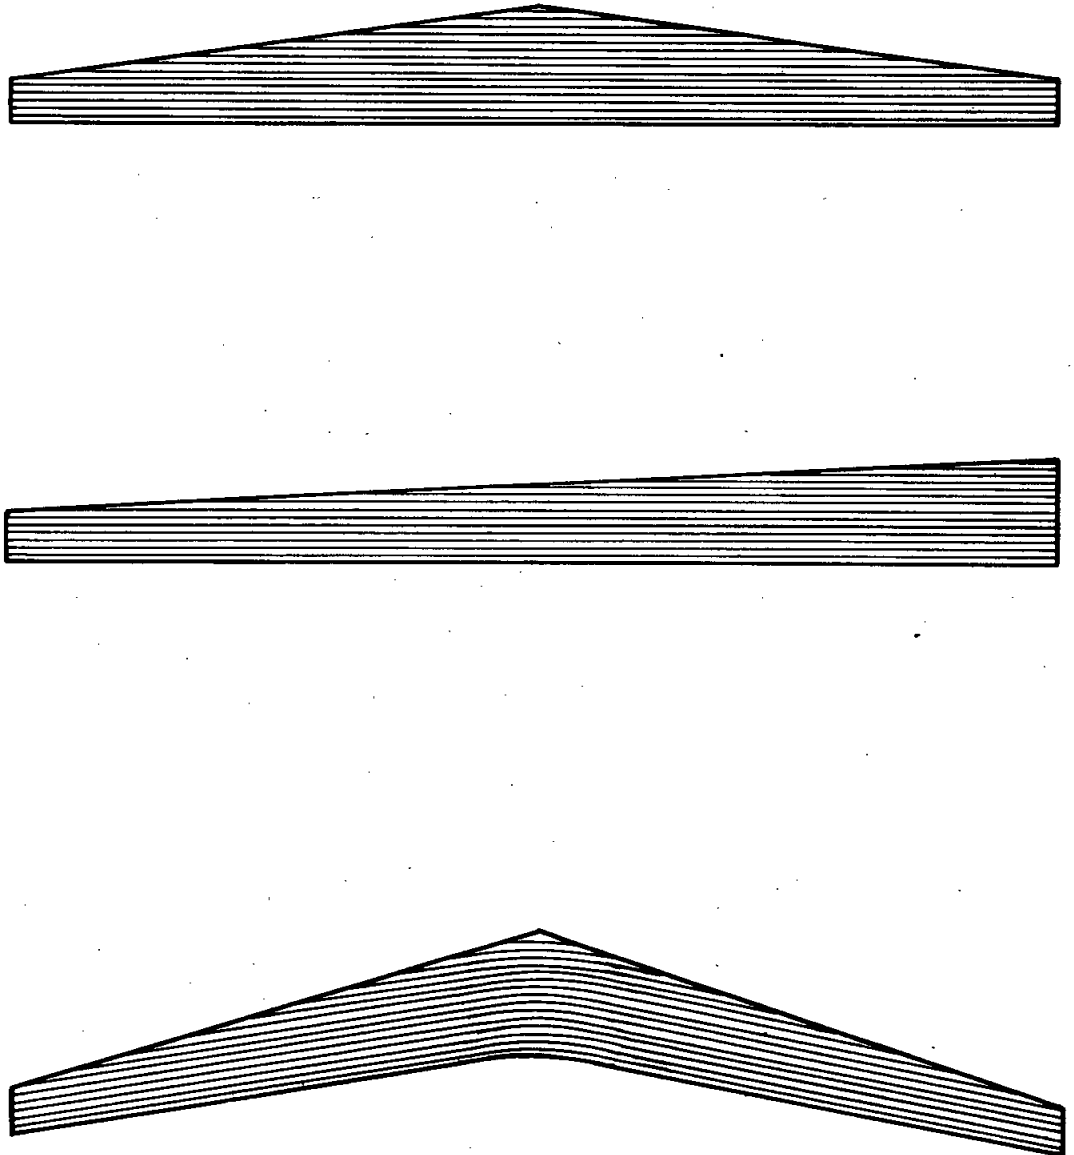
Vigas laminadas de sección transversal variable.
